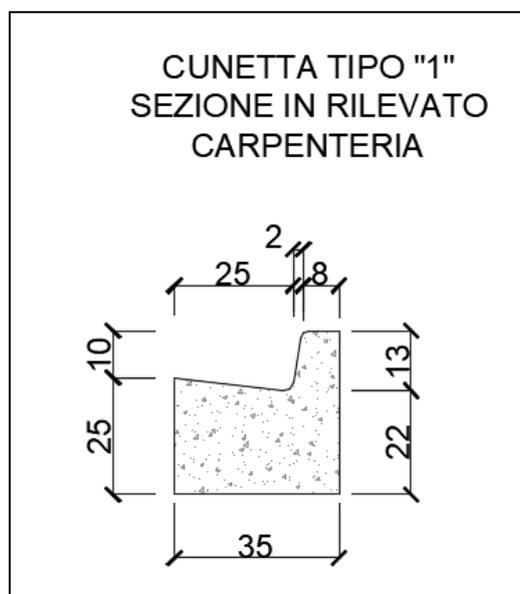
Sistema di scarico in rilevato – cunetta tipo "1"
